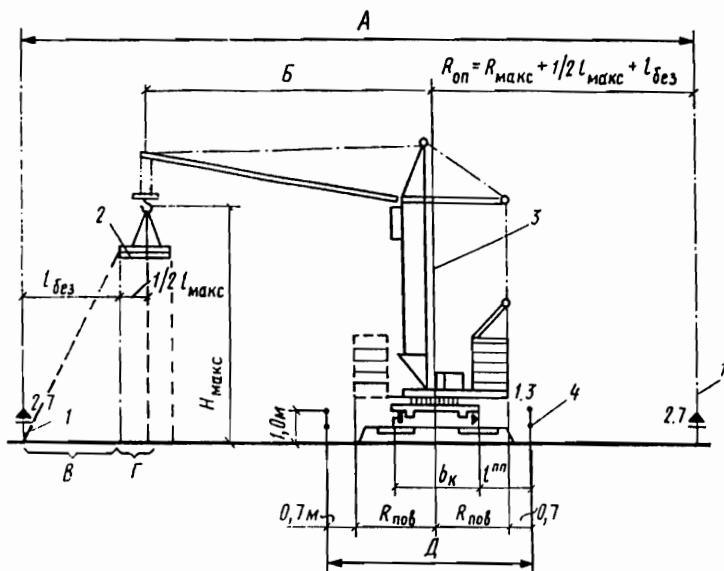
Схема назначения и расчета зон башенного крана: 1 – знак по технике безопасности на границе опасной зоны; 2 – груз; 3 – ось подкрановых путей; 4 – инвентарное ограждение подкрановых путей; А – опасная зона при работе крана; Б – зона обслуживания; В – зона рассеивания при падении груза; Г – зона перемещения груза; Д – опасная зона путей
